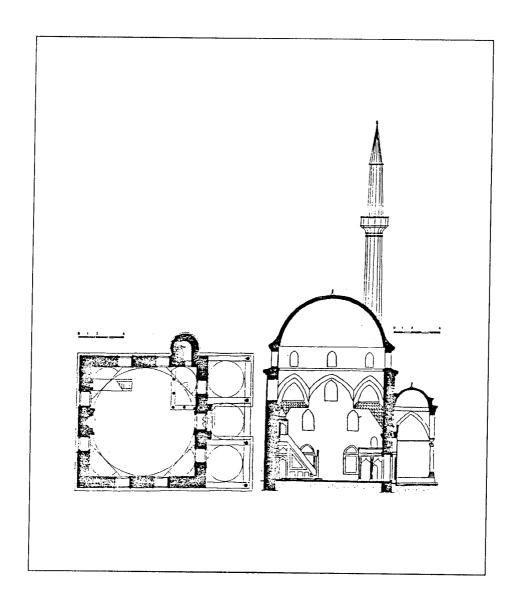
مسقط أفقي لمسجد الآجا في قالقاندلن (عن : Ibrahimgil) .
